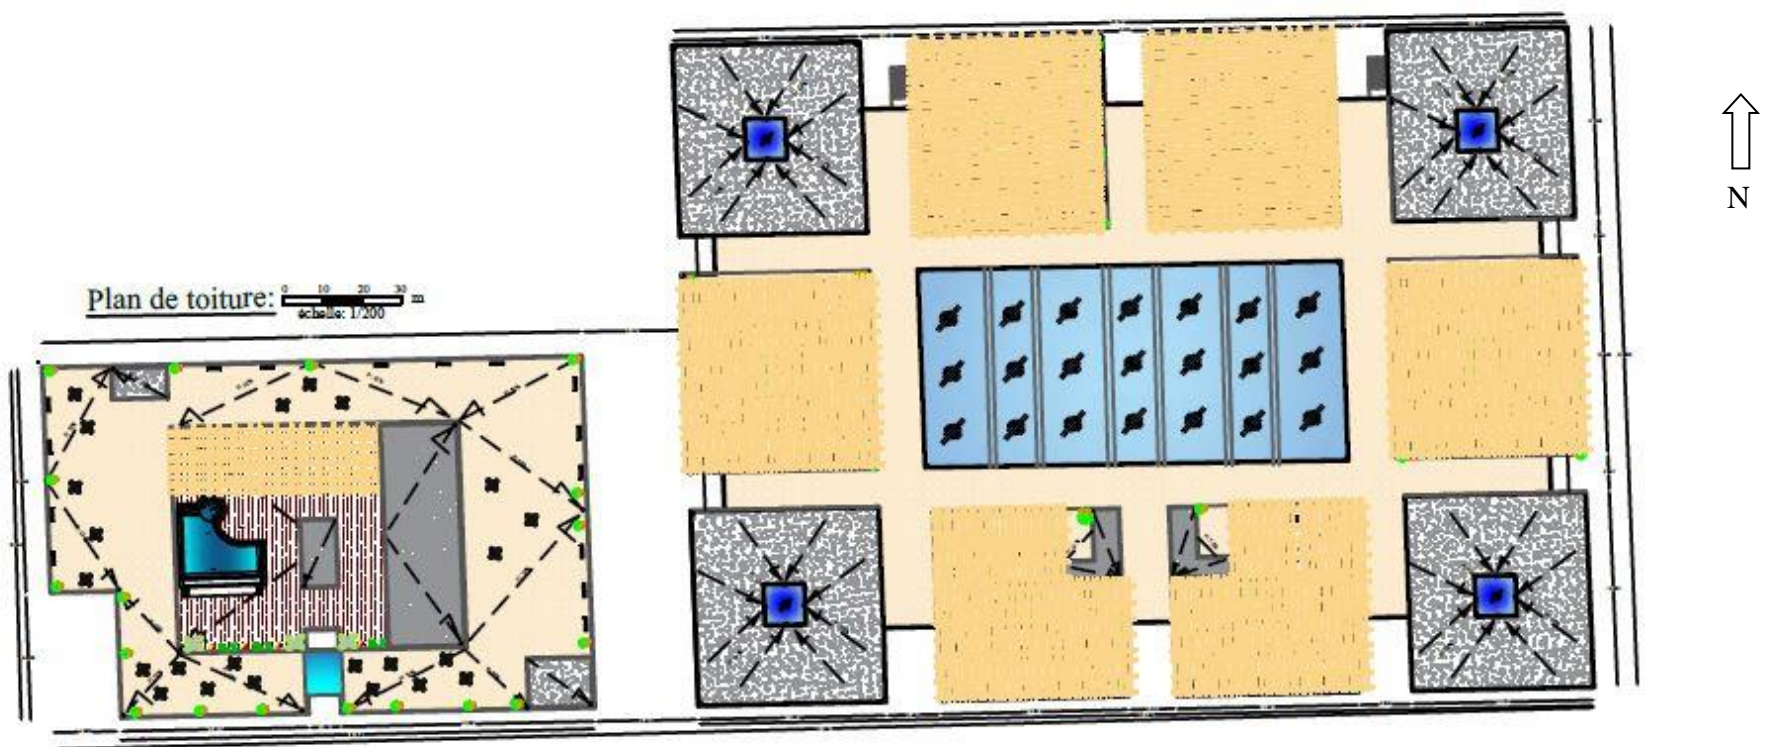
Plan de toiture/Source : Traiter par l'auteur.
